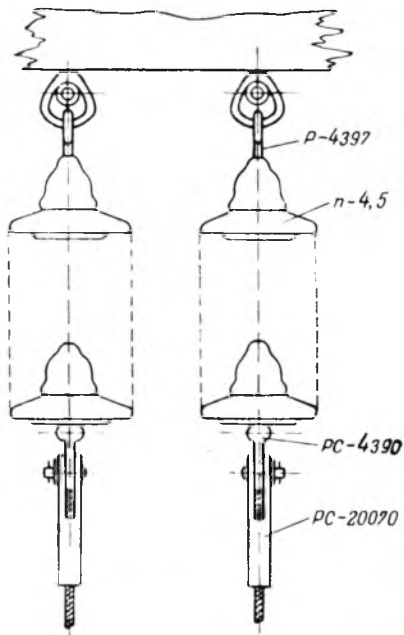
Крепление провода на анкерной опоре на отдельных гирляндах.
